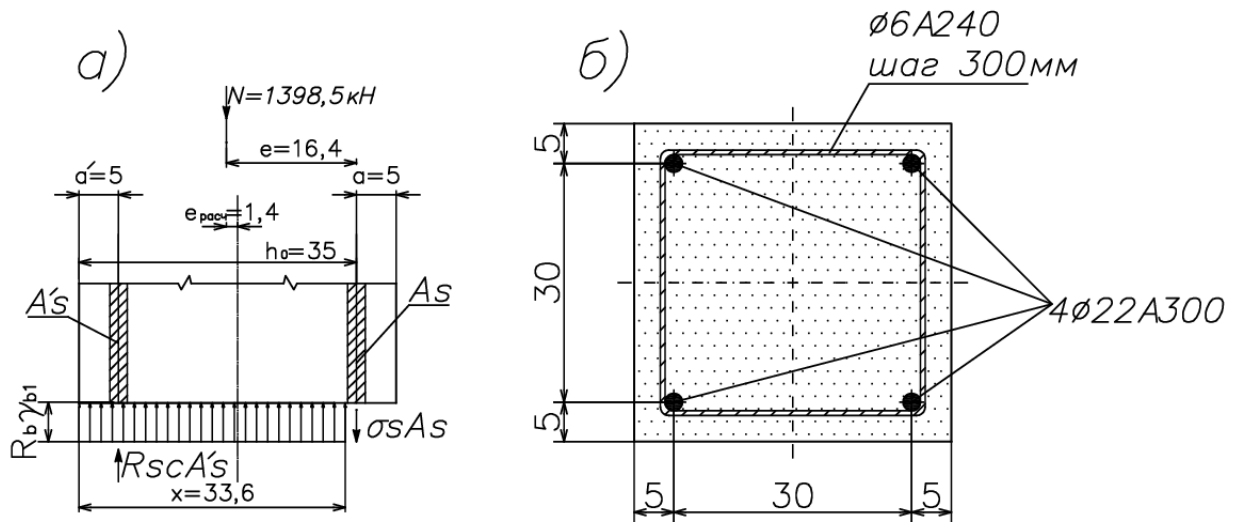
Расчетная схема нормального сечения колонны.
